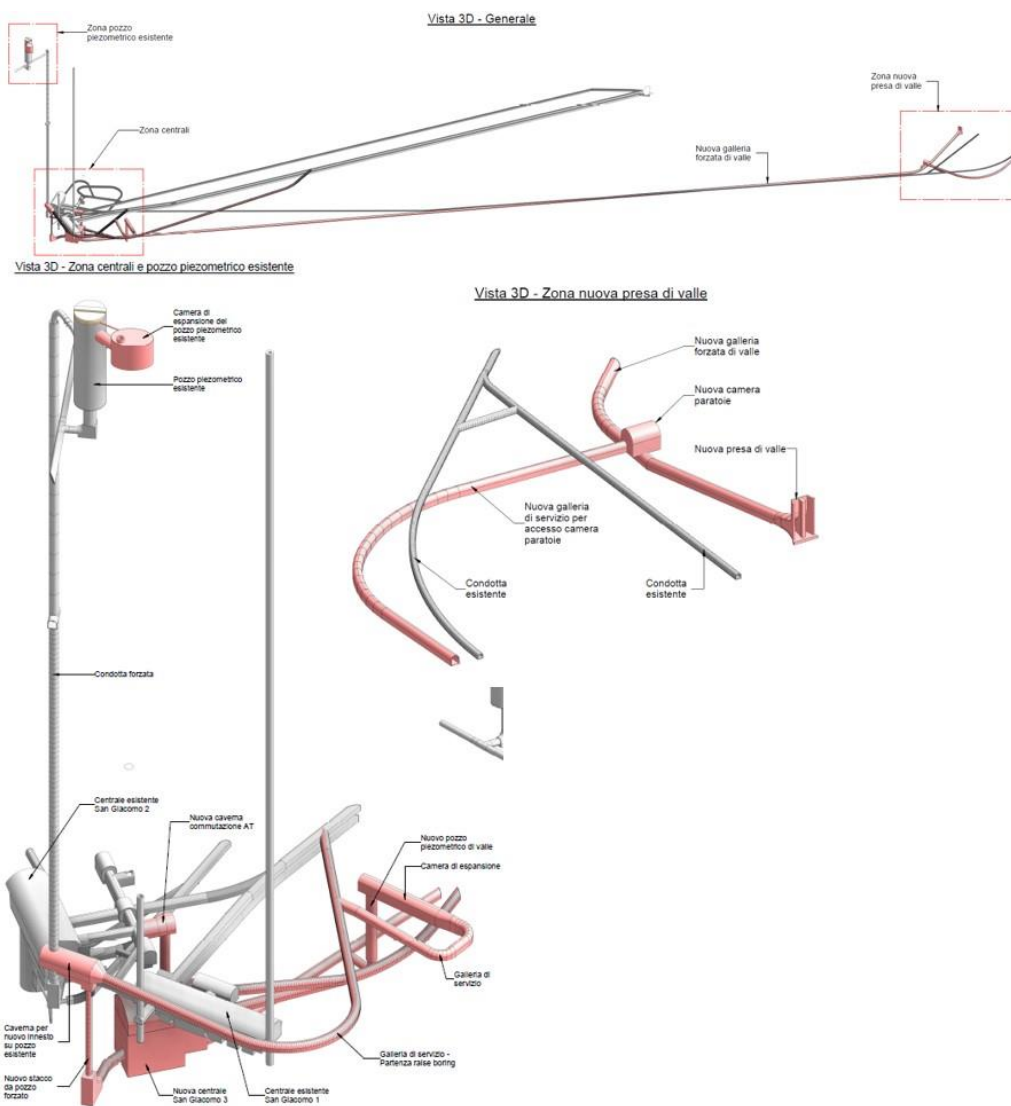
Elementi di progetto – modello 3D, estratto dall'elaborato GRE.EEC.D.29.IT.H.51386.00.155.00 Comparativo Modello 3D
